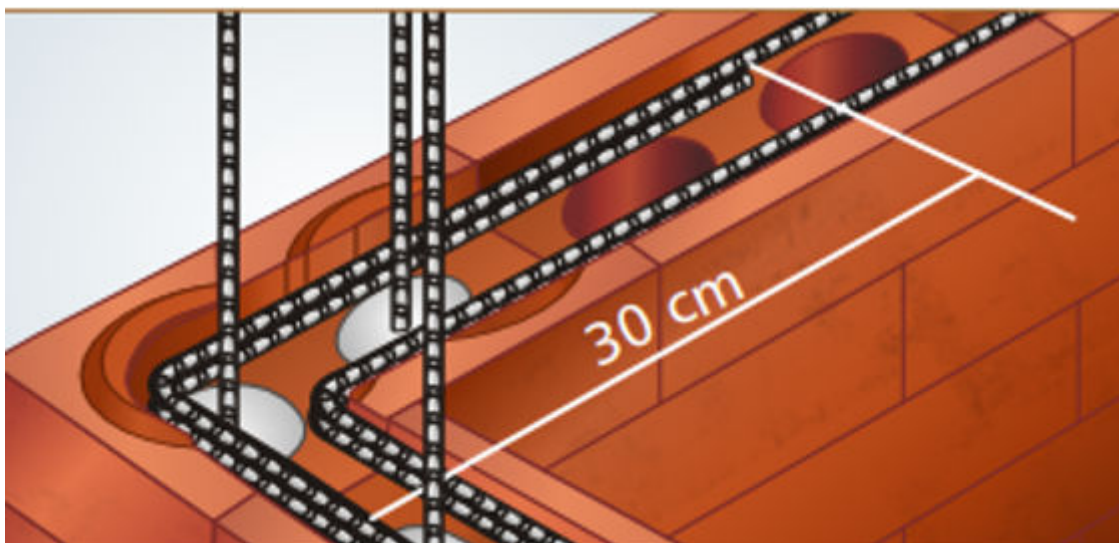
Detalhe da disposição das barras horizontais das canaletas
